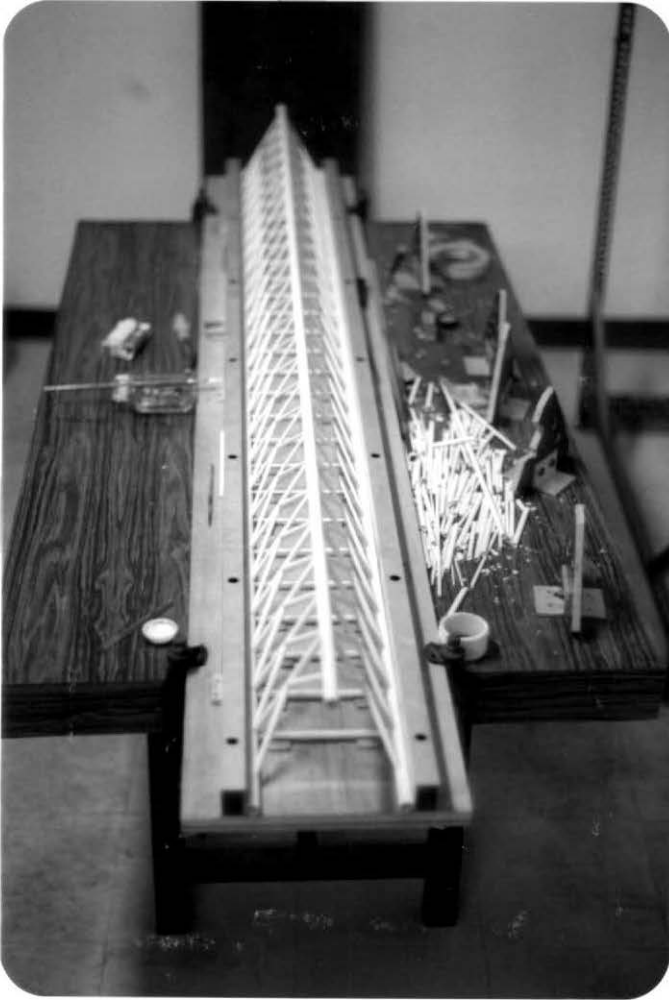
Modelo com duas faces construídas e com a terceira em fase de construção
